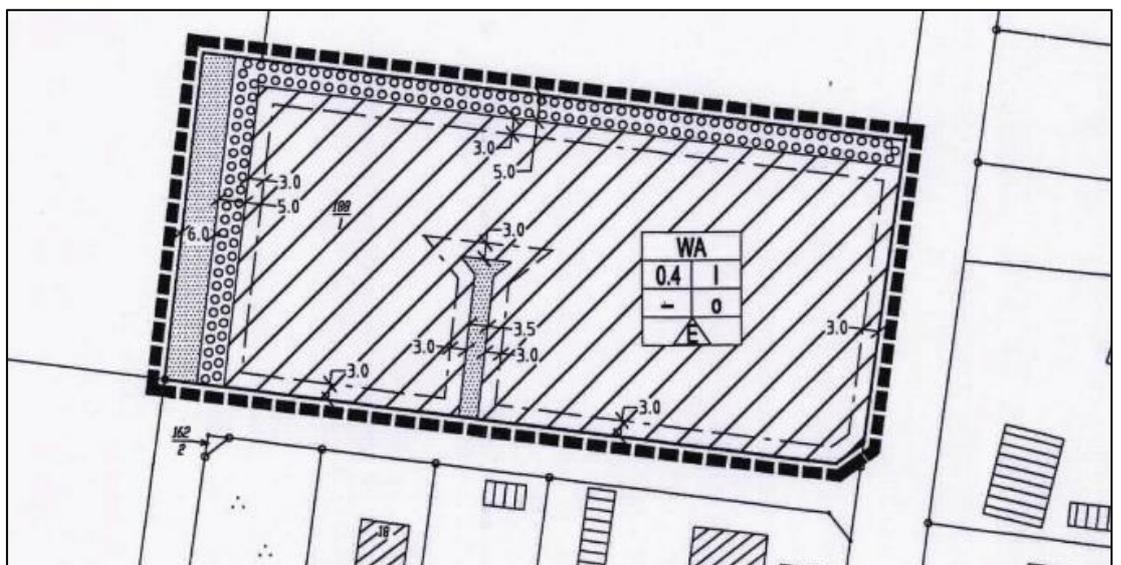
Bebauungsplan Nr. 6 „Kamp“
